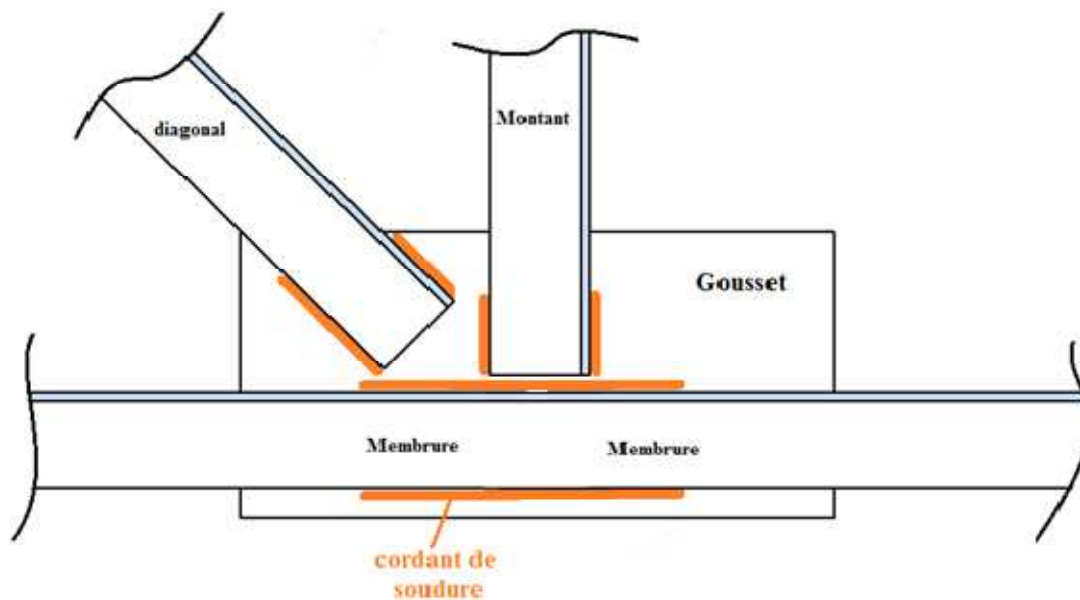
Détail assemblage Gousset- éléments de la ferme
